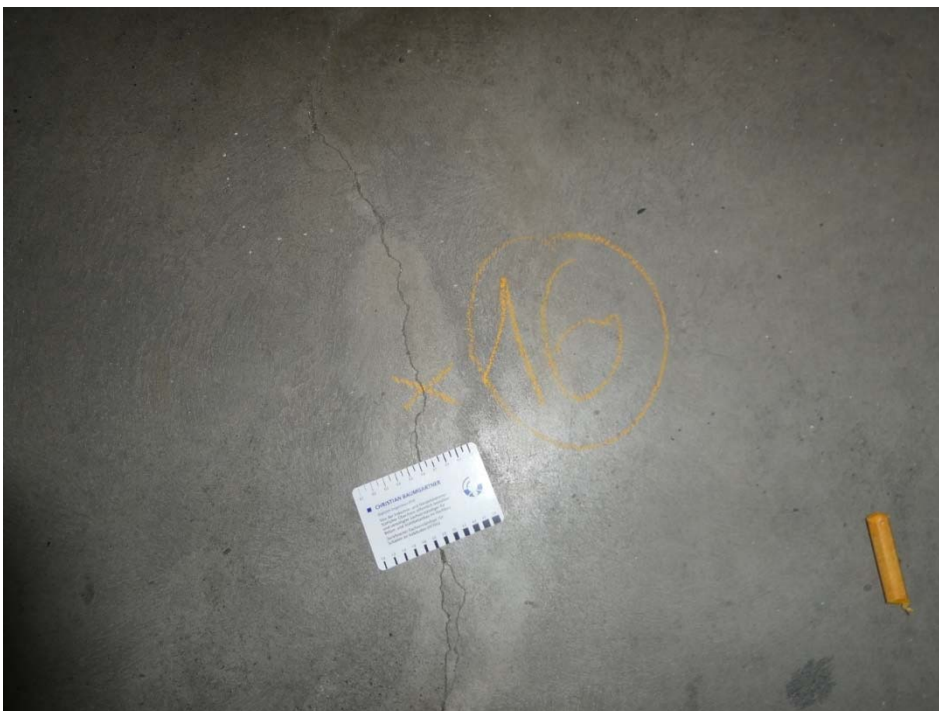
Untersuchungsstelle 16 – Bodenfläche Bereich Riss Breite ca. 0,6 mm
